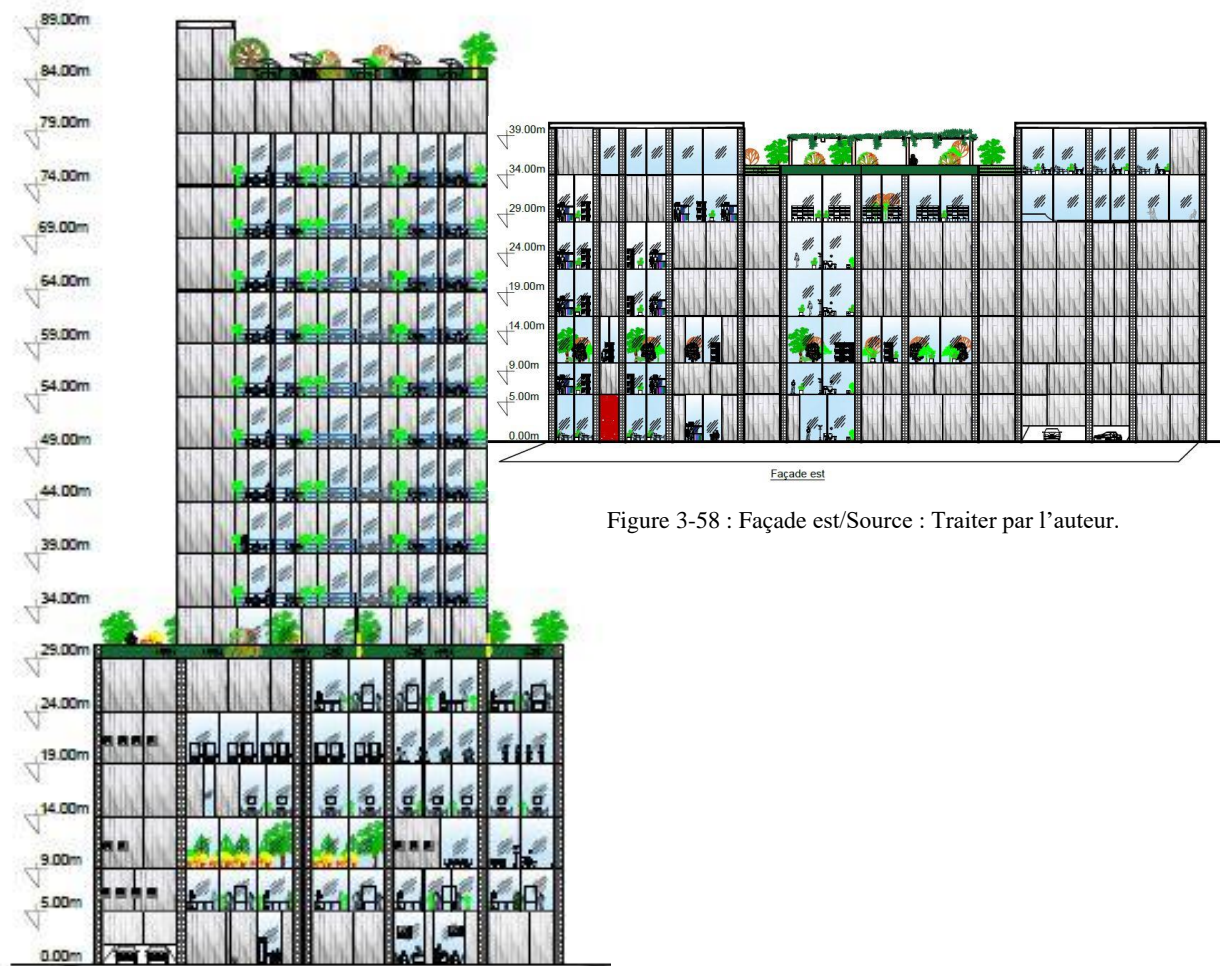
Façade est/Source : Traiter par l'auteur.
